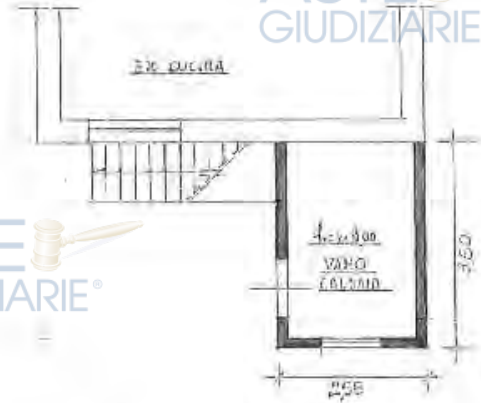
Estratto Autorizzazione prof. 1100 del 13/07/1976 per "costruzione di un locale adiacente all'ex cucina del ristorante da adibire ad installazione di una caldaia a vapore"
